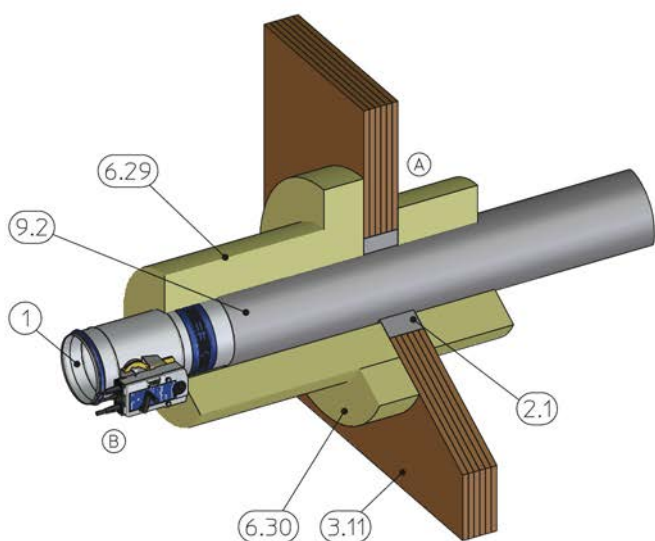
Монтаж без строительного раствора в сплошной деревянной стене или в стене из поперечно-клееной древесины с монтажным комплектом TQ / TQ2
